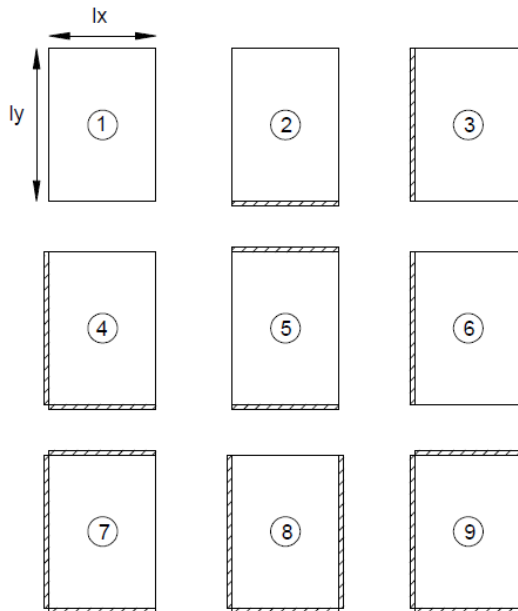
Vinculações das lajes que trabalham em duas direções.
